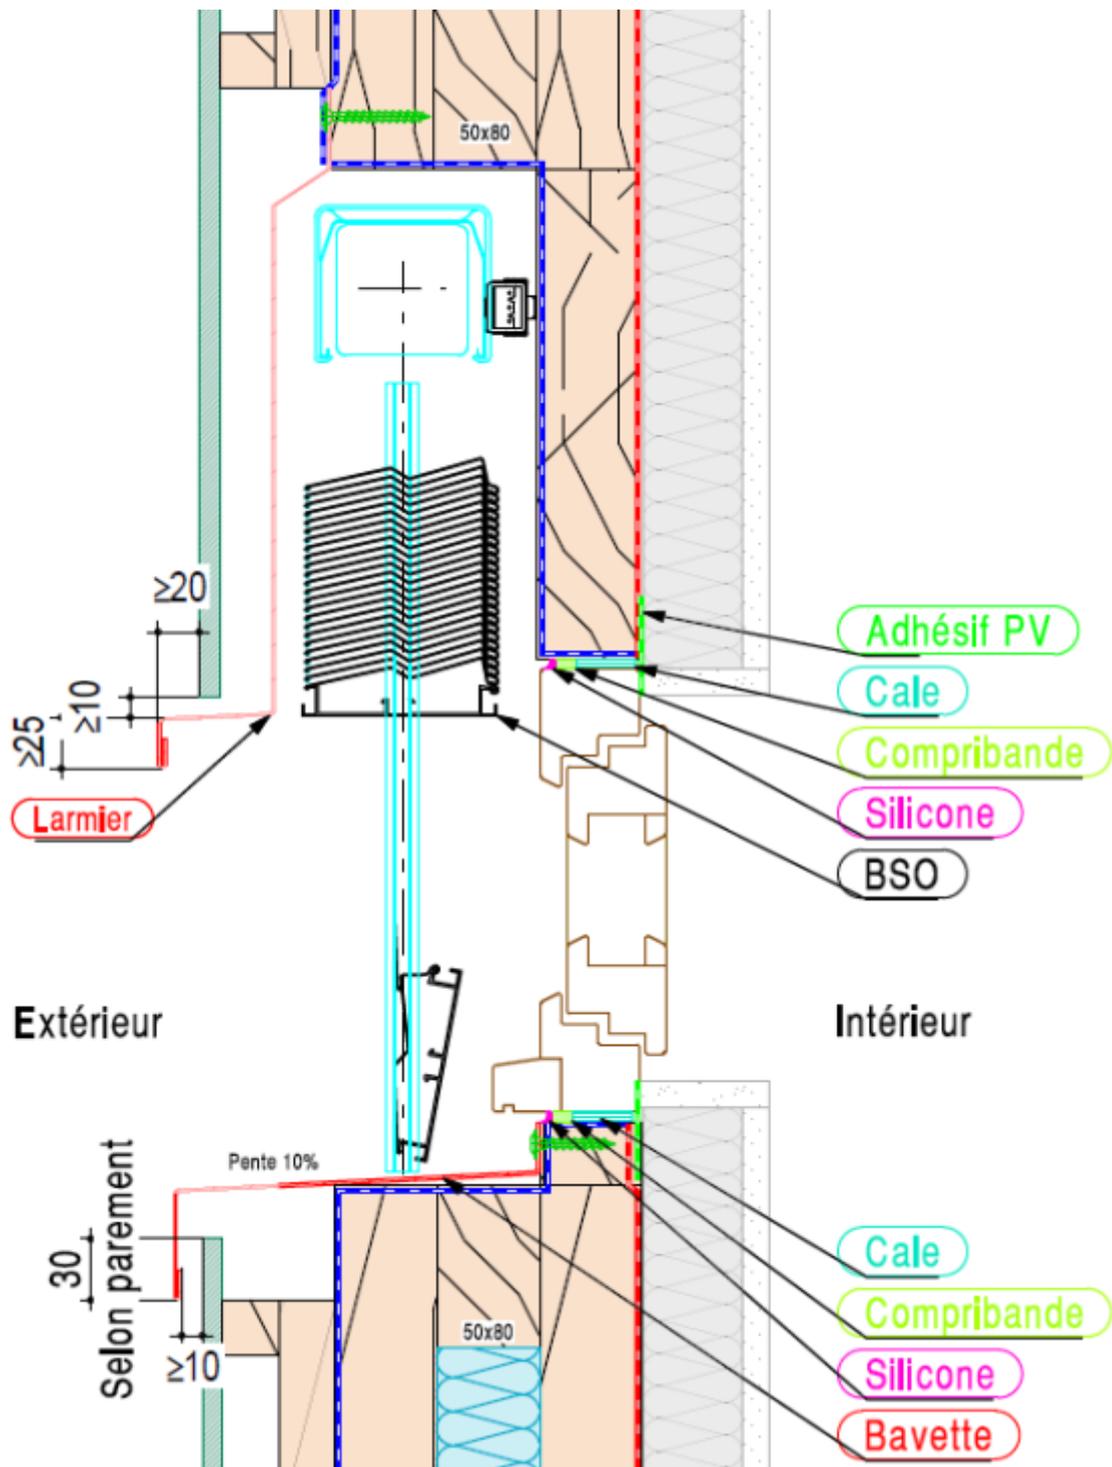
Menuiserie avec brise-soleil en tunnel au nu intérieur / Coupe verticale
